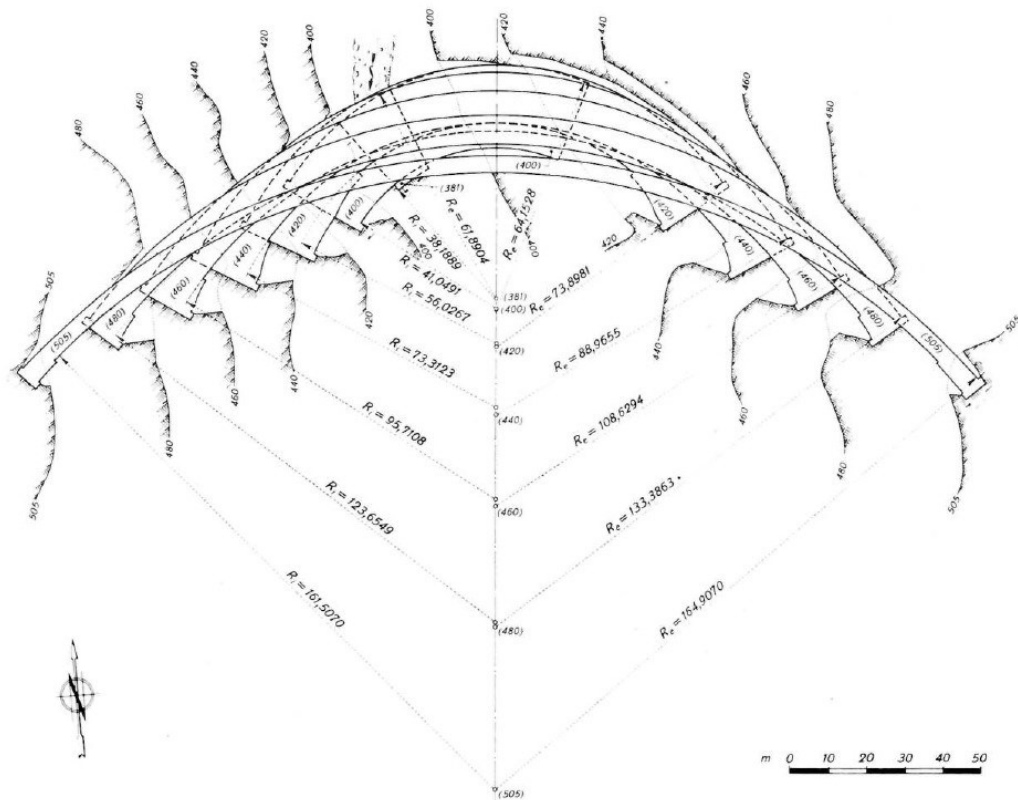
Sezione maestra ed elementi geometrici per il tracciamento degli archi
